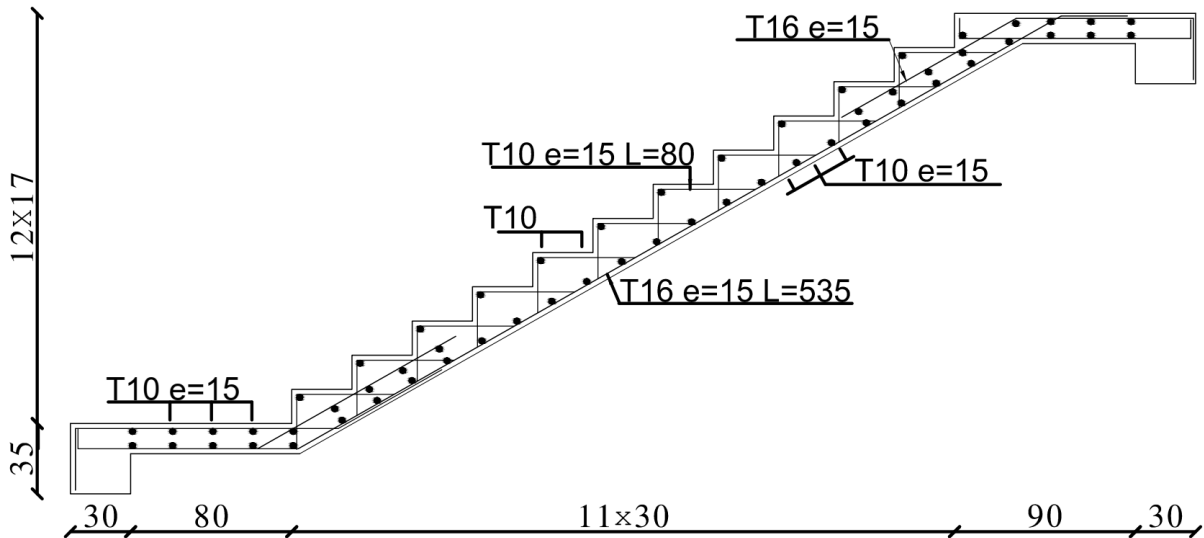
Ferrailage de l'escalier de rez de chaussée
